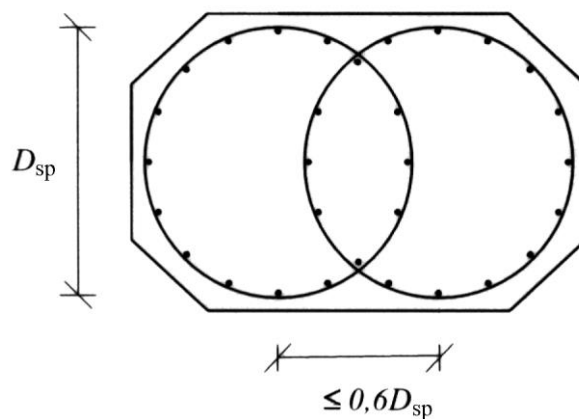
Detalles constructivos típicos del confinamiento de pilas de hormigón utilizando espirales/cercos entrelazados
